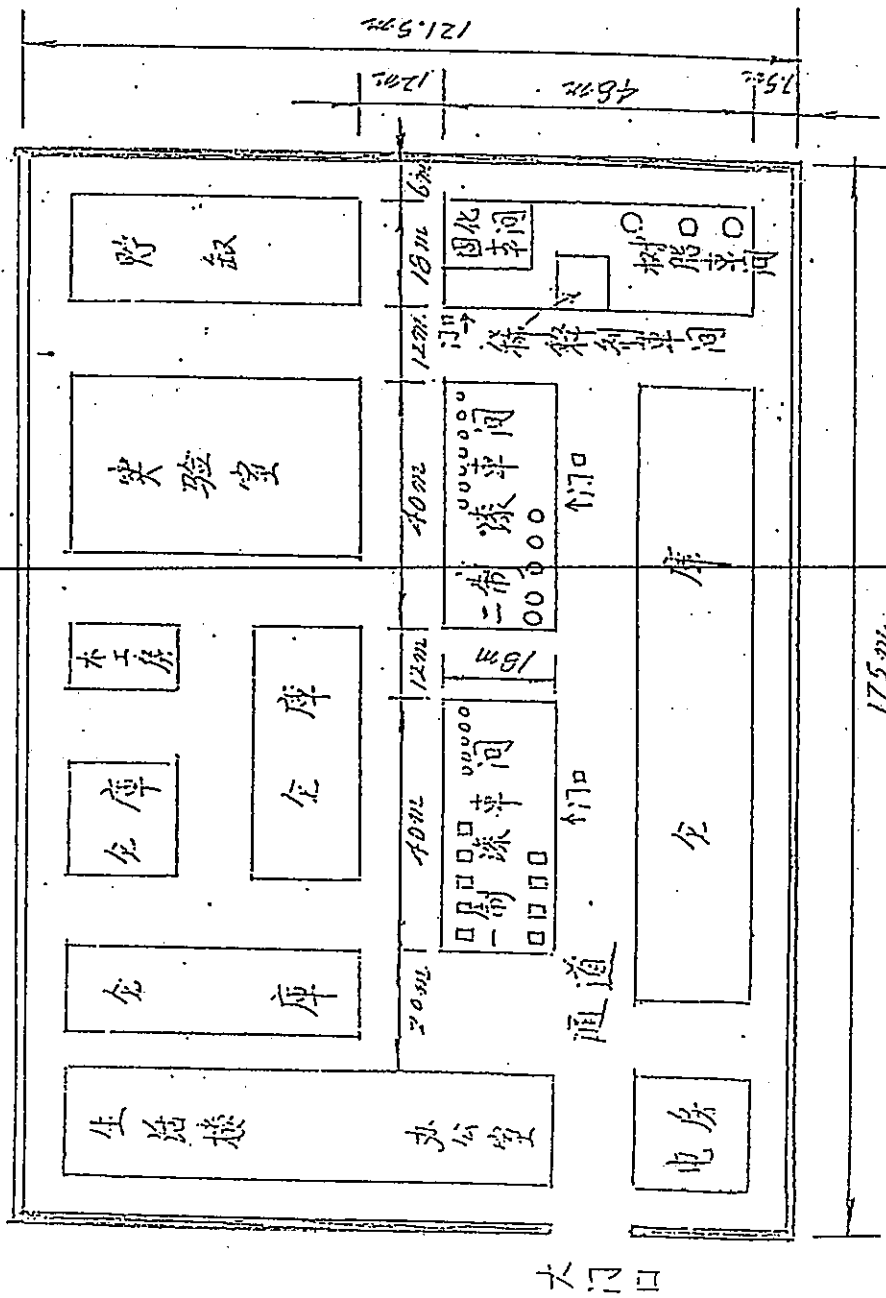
嘉宝莉化工有限公司平面布置图 1:1000
